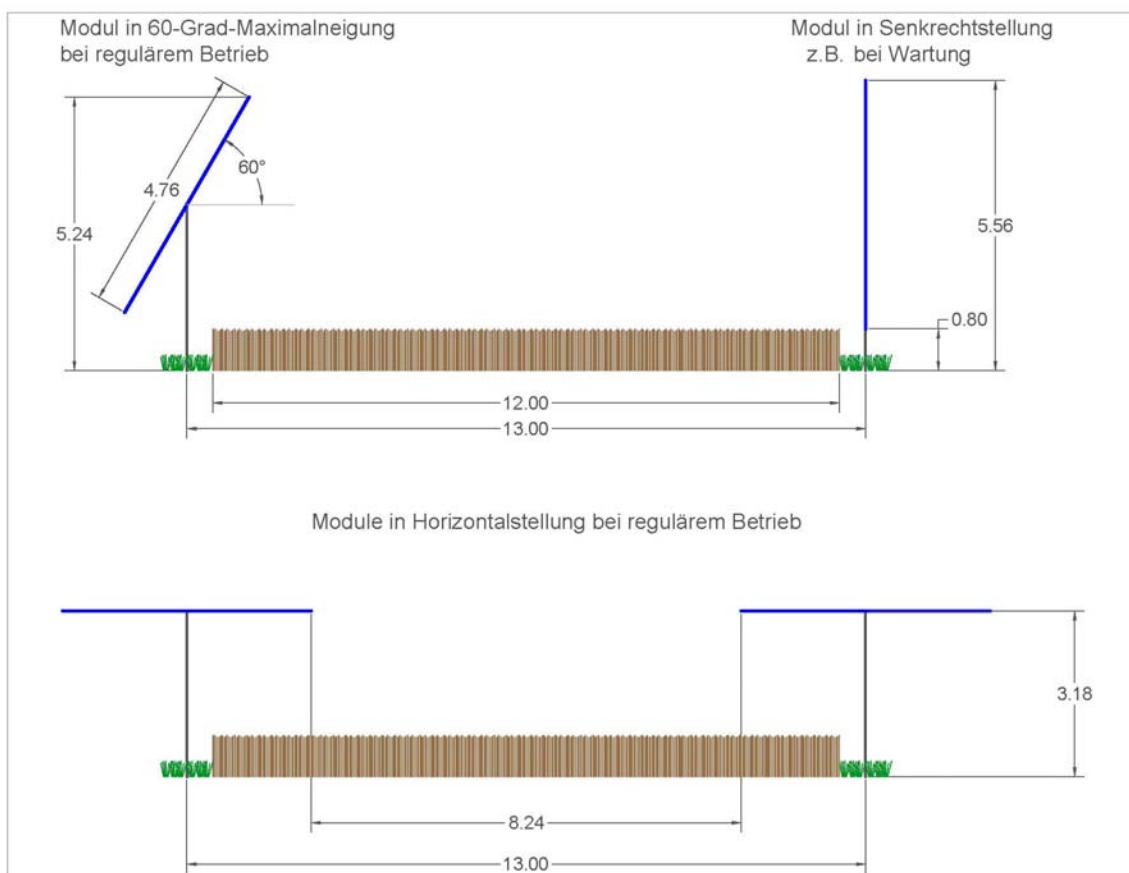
Systemskizze des geplanten Agri-PV-Parks mit zwei Modulen
